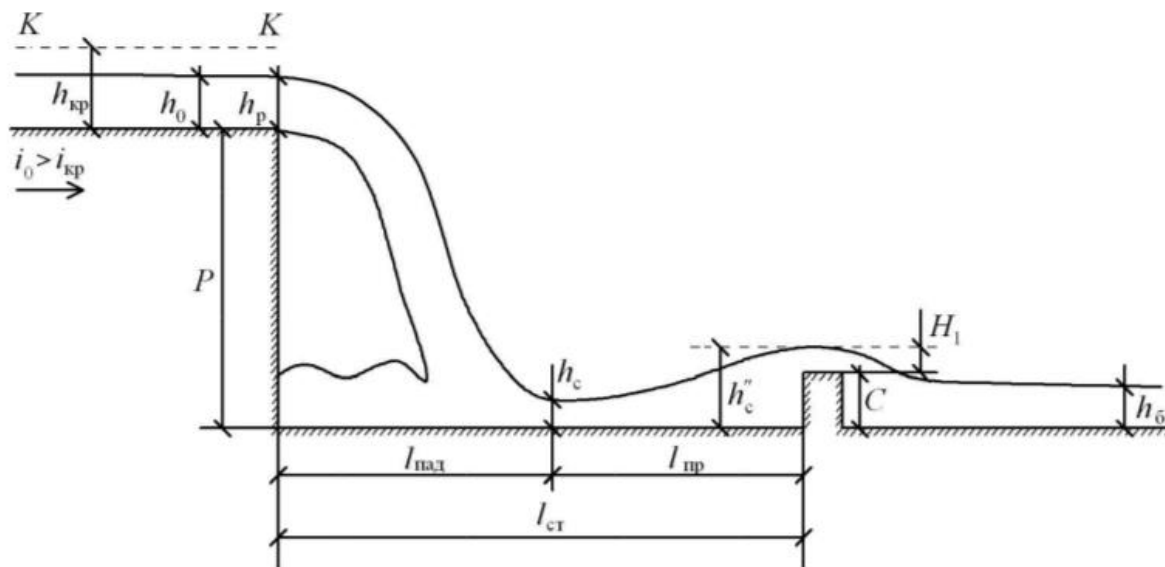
Гидравлическая схема расчёта стенки падения с водобойной стенкой
